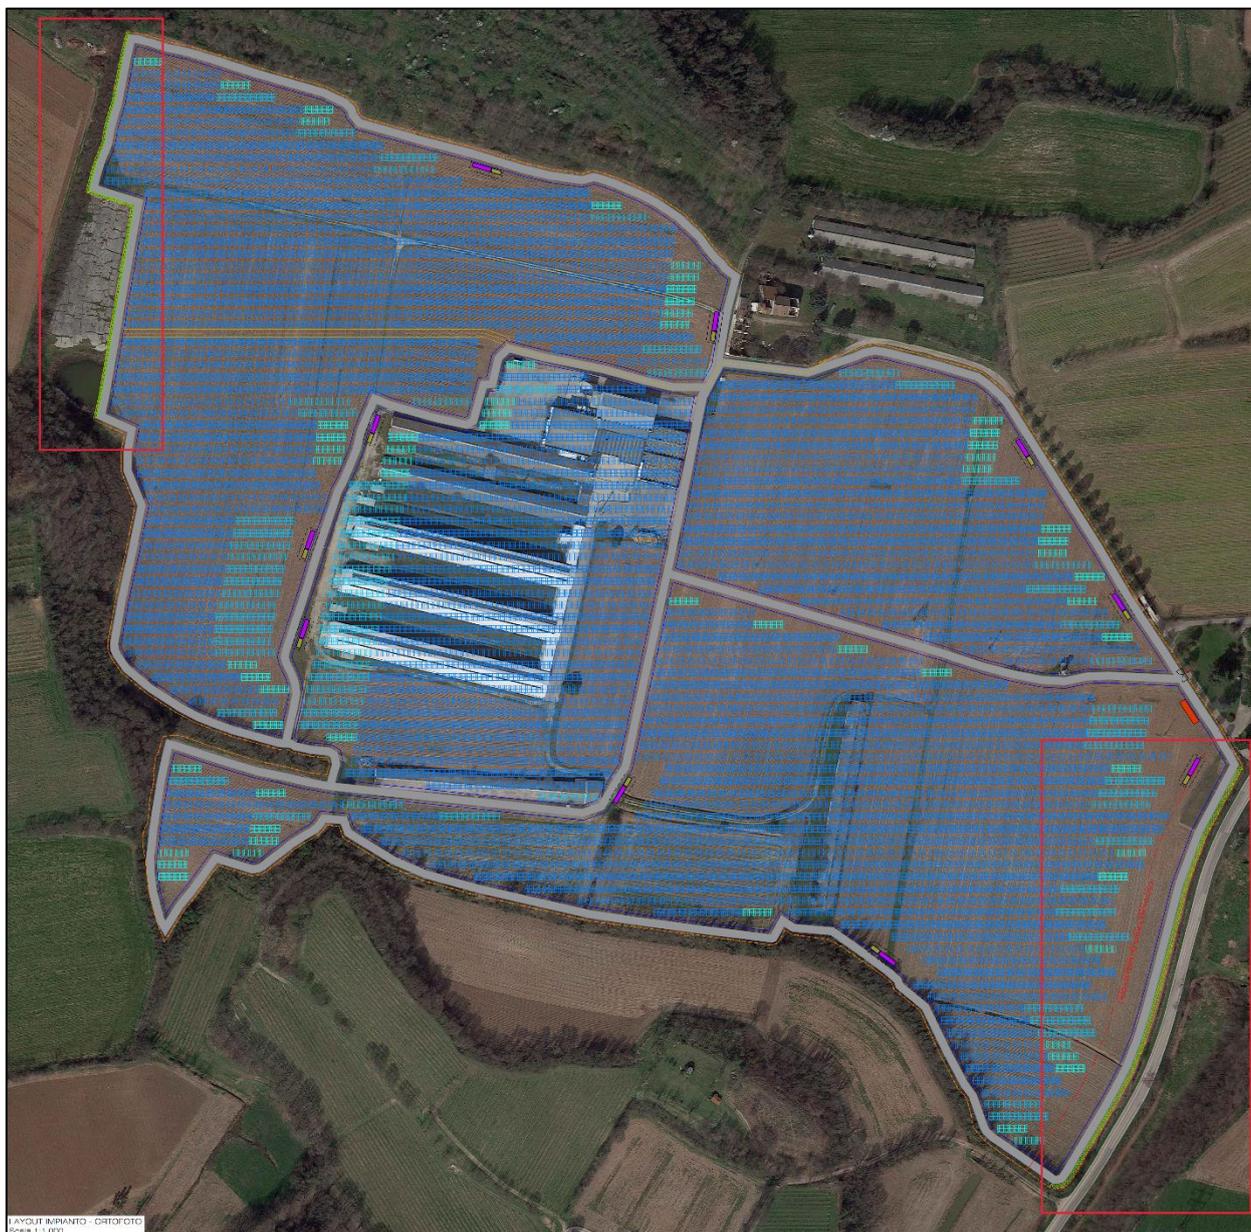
Layout dell’impianto su ortofoto e indicazione (nei riquadri in rosso) della posizione delle opere di mitigazione previste
